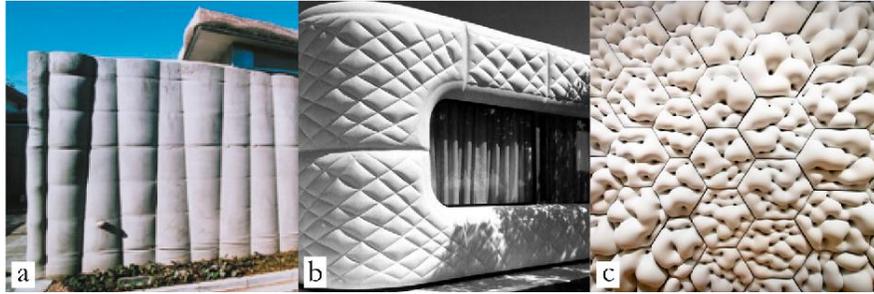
a. Muro de Kenzo Unno. b. Fachada de Miguel Fisac. c. Muro de Matsys Design. TAILORED FLEXIBILITY Reinforcing concrete fabric formwork with 3D printed plastics, pág. 3.
